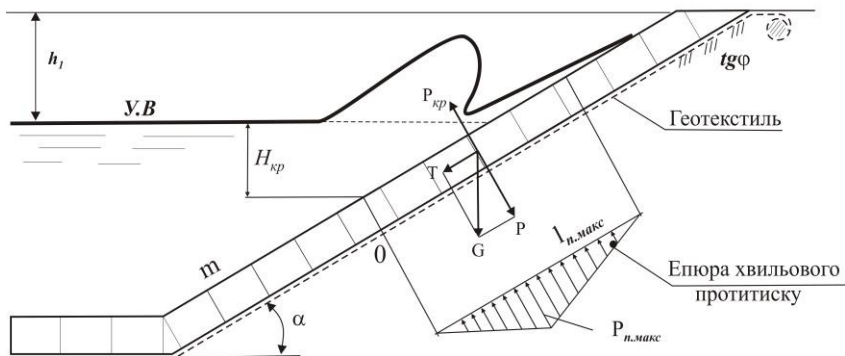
Навантаження на кріплення при обрушенні вітрової хвилі
